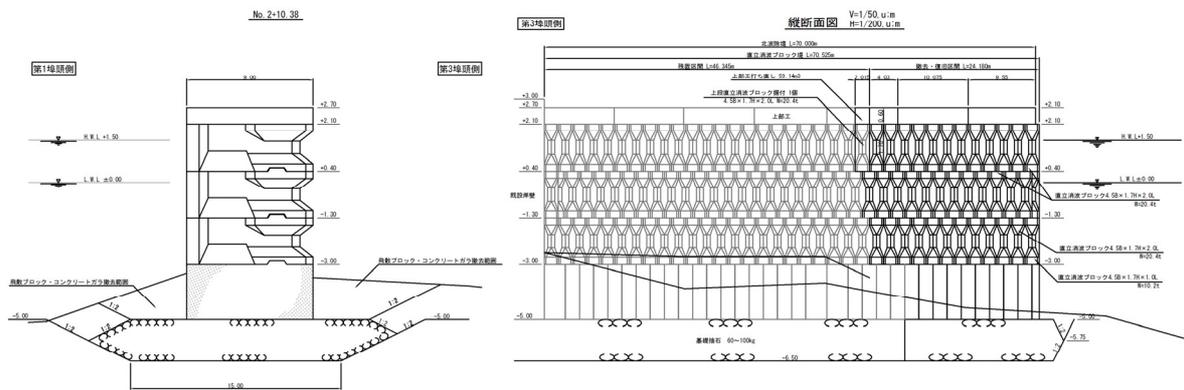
No.5 大洗港区_北波除堤の断面図（復旧後）
